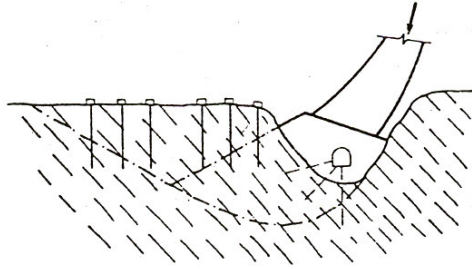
Estabilización utilizando anclaje y drenaje (CFE, 1981).
